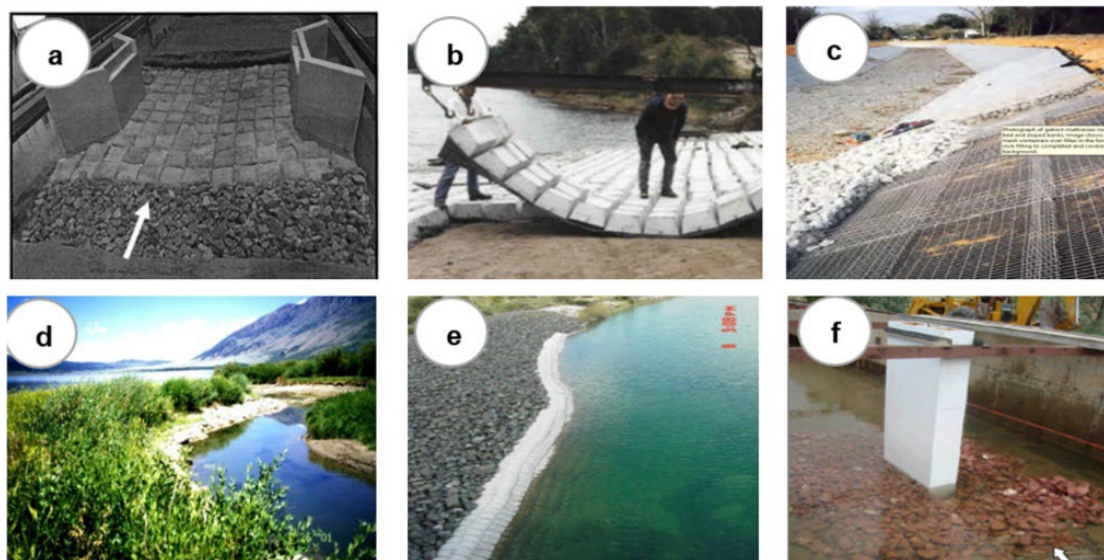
Contramedidas de blindaje: a) Geo bolsa en estribos; b) Bloques atados con cables; c) Colchones de gaviones; d) Rip-rap con vegetación; e) Bloques de hormigón articulados; f) Rip-rap en pilar
